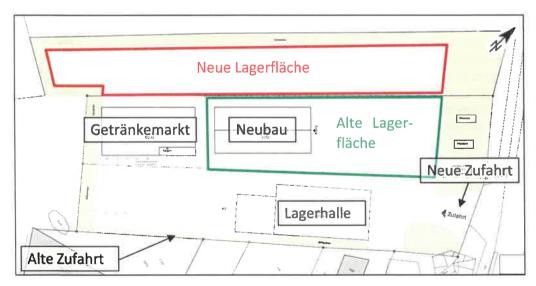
Lageplan Vorentwurf Neubau einer Lagerhalle, Friedenauer Architektur, Stand 22.10.2017
